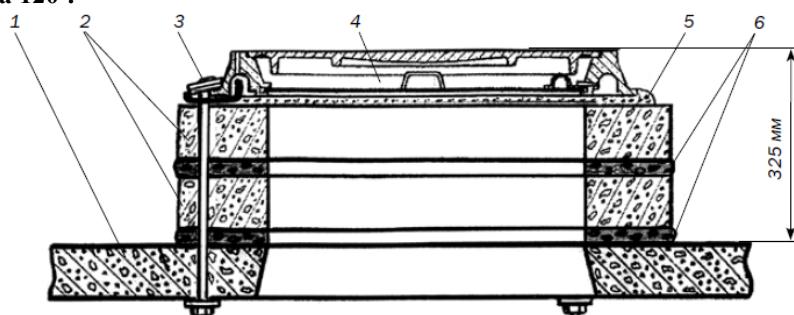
Крепление опорных колец и люка с помощью «СНКЛ-3»:
